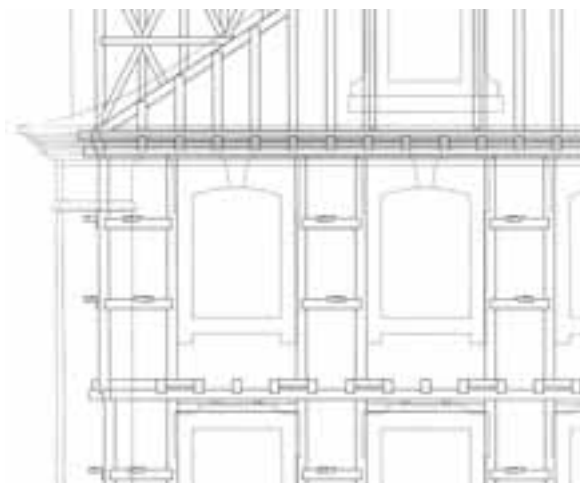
Ampliação da vista da estrutura de madeira do frontal exterior.
